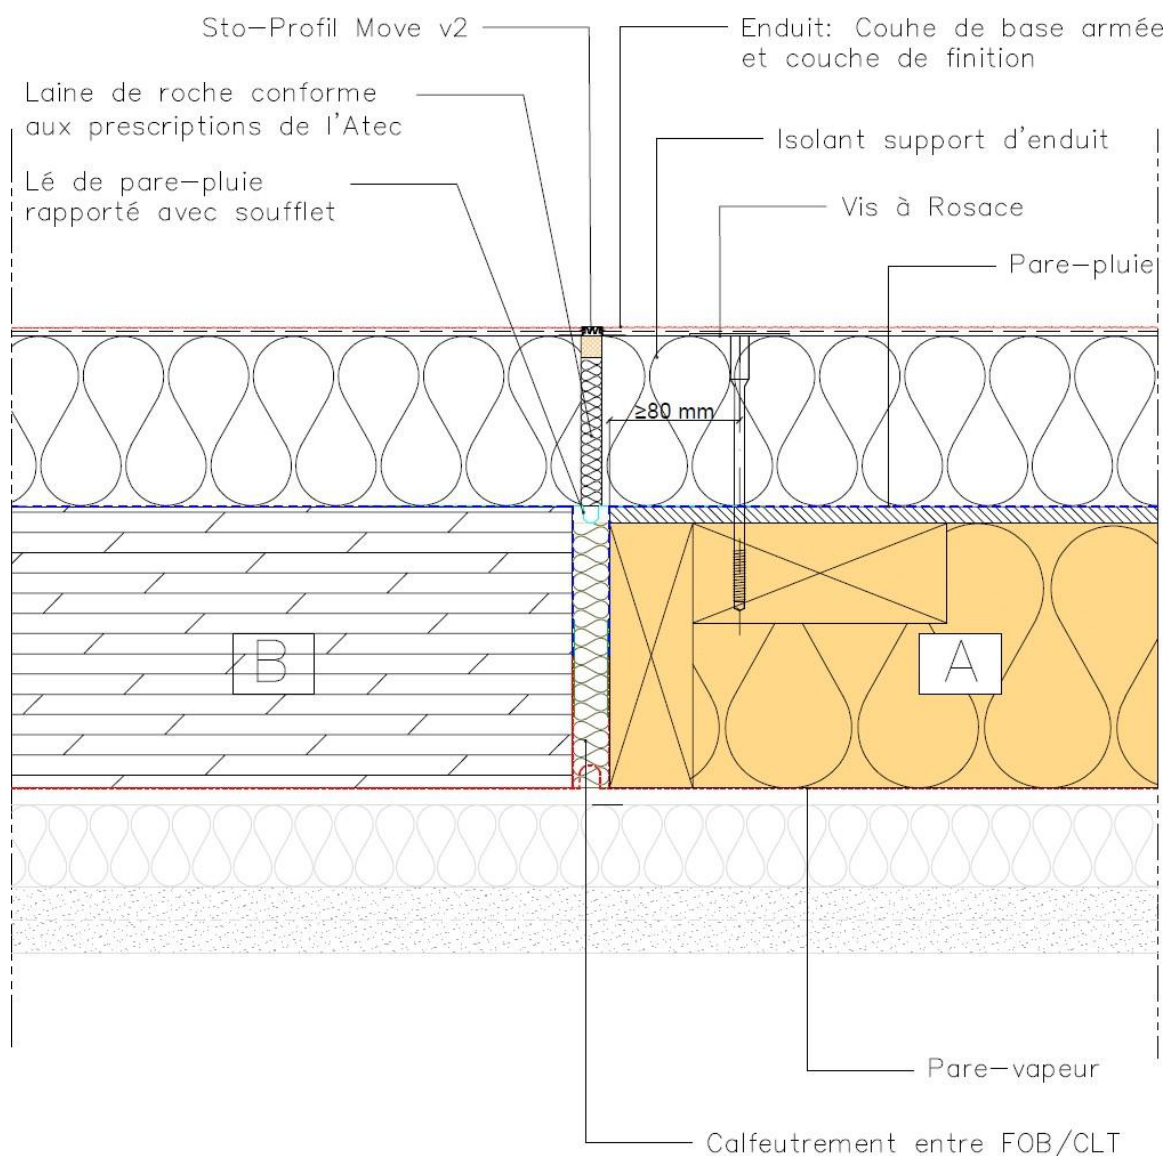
Jonction FOB / CLT dans le même plan et avec ETICS - Sto-Profil Move2 - Coupe Horizontale
